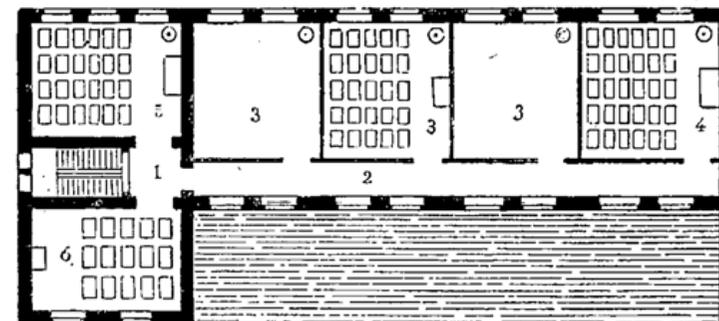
Plan de rez-de-chaussée d'une école urbaine française du XIXème siècle
